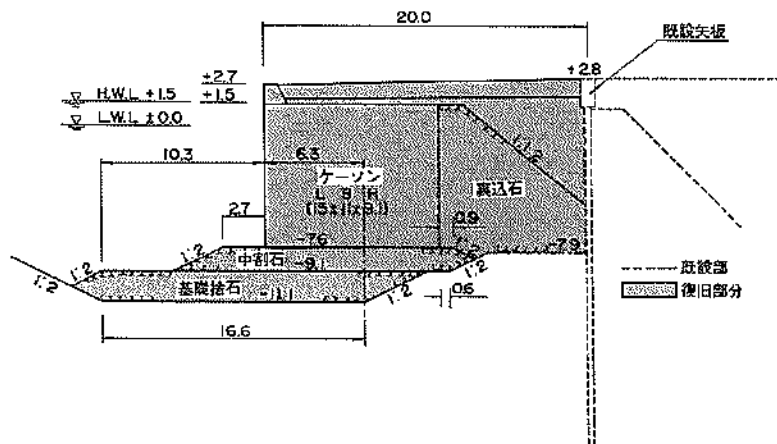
東港北埠頭岸壁 (-8.1m) 復旧断面図
